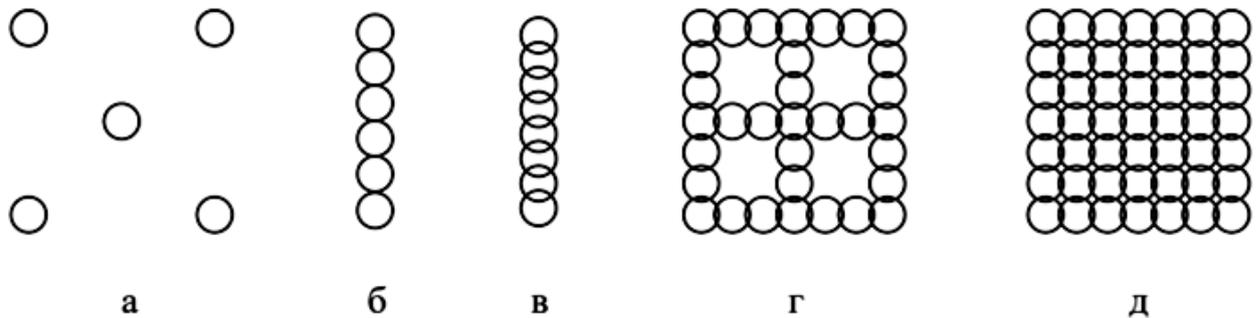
Основні схеми армування у плані за D. Ruffing: а – окремі елементи, б – лінійні дотичні, в – лінійні перехресні, г – сітка, д – масивний блок
